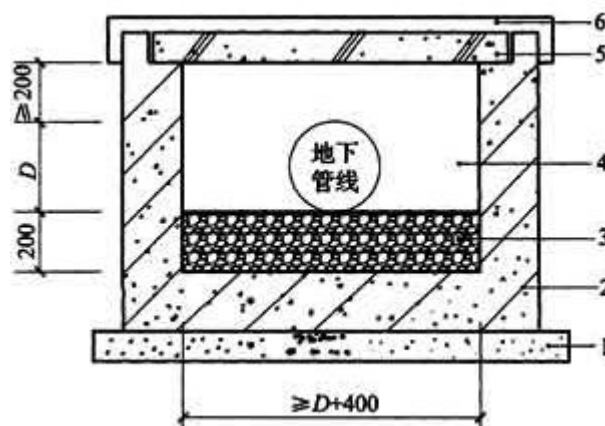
抗渗钢筋混凝土管沟防渗层示意
